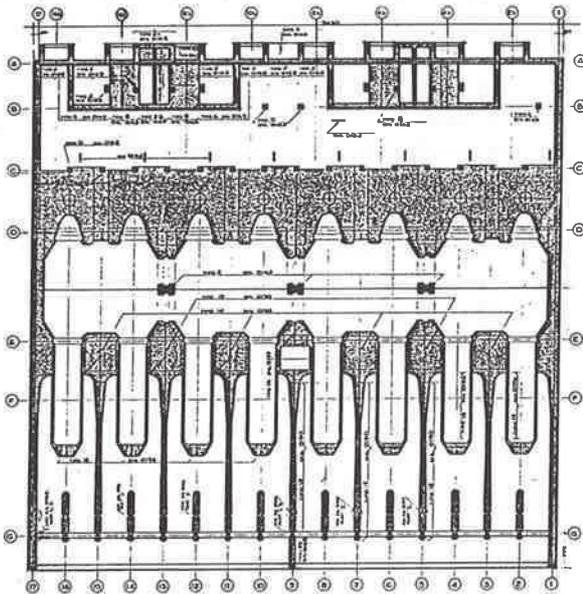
Pianta dell'Edificio Vasca Griglie e Pompe
